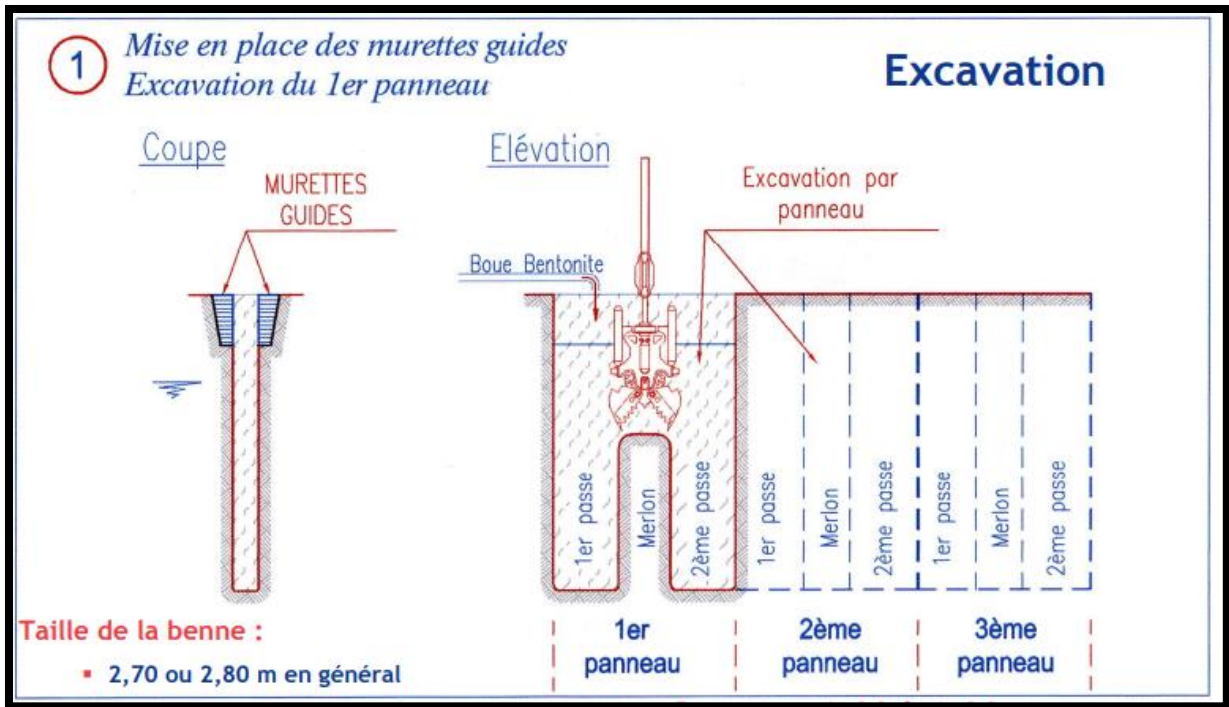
Mise en place des murettes guides, Excavation du 1^{er} panneau.
